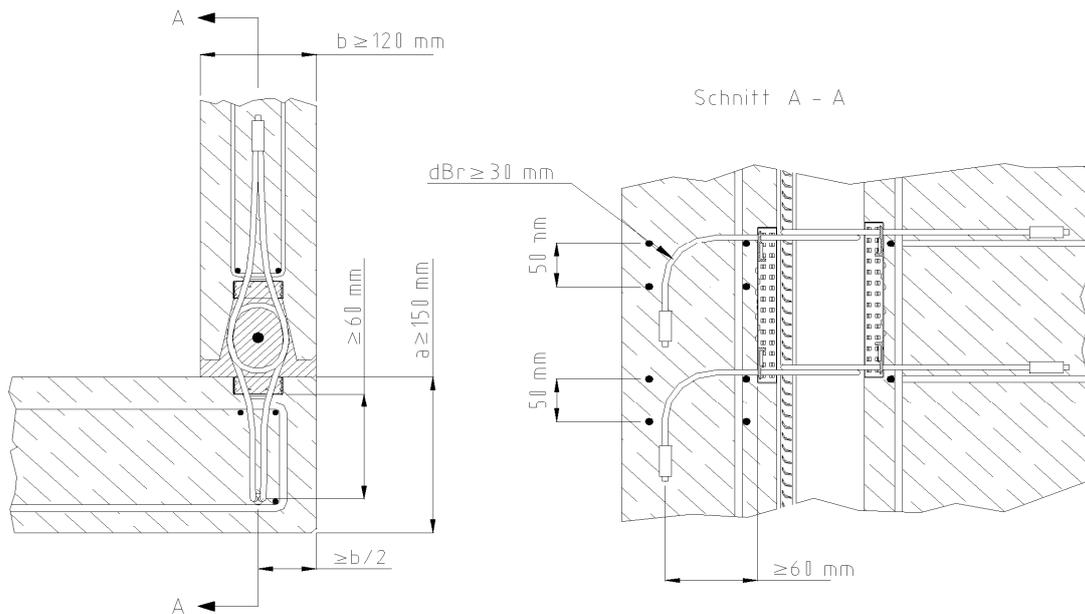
Wand – Wand – Eckverbindung - Detail mit abgewinkelten Seilschlaufen
